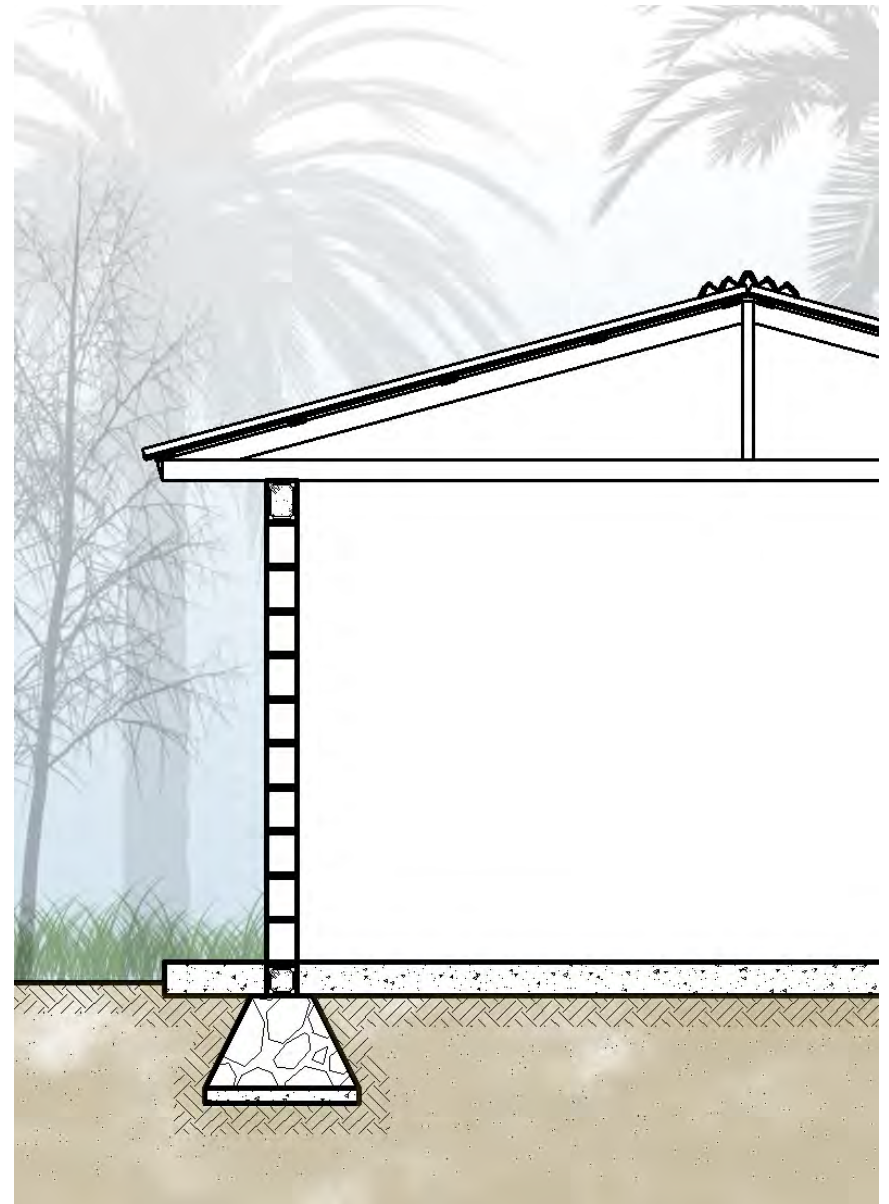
Corte arquitectónico de método constructivo industrial, con cimentación d piedra, muros de block, piso de concreto y cubierta de cerchas de madera y láminas galvanizadas.
